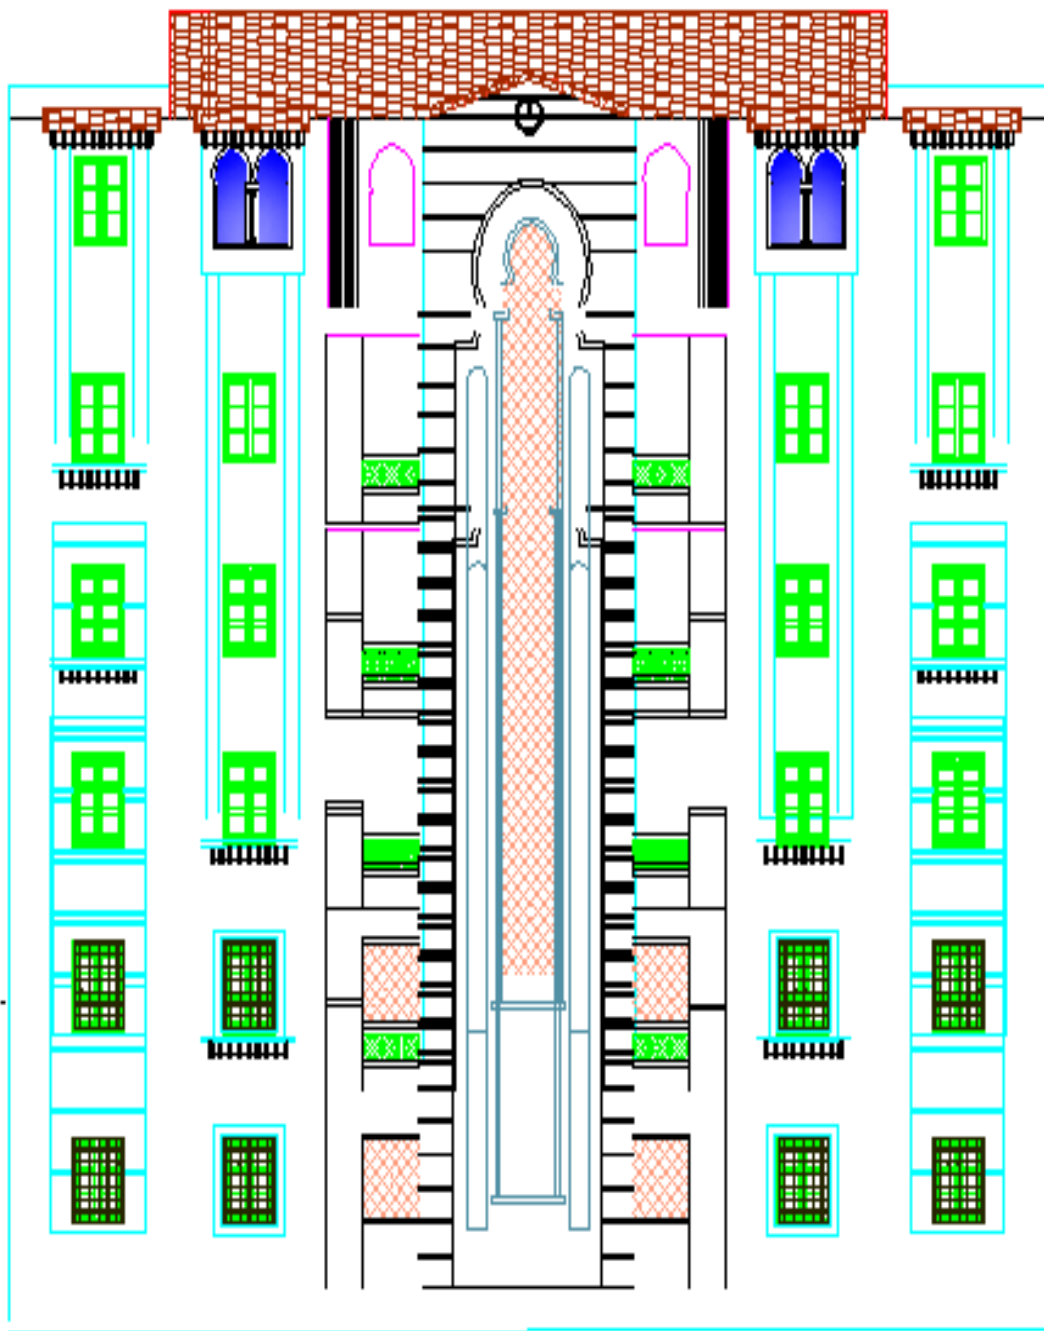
Vue en façade (Echelle : 1/100)
